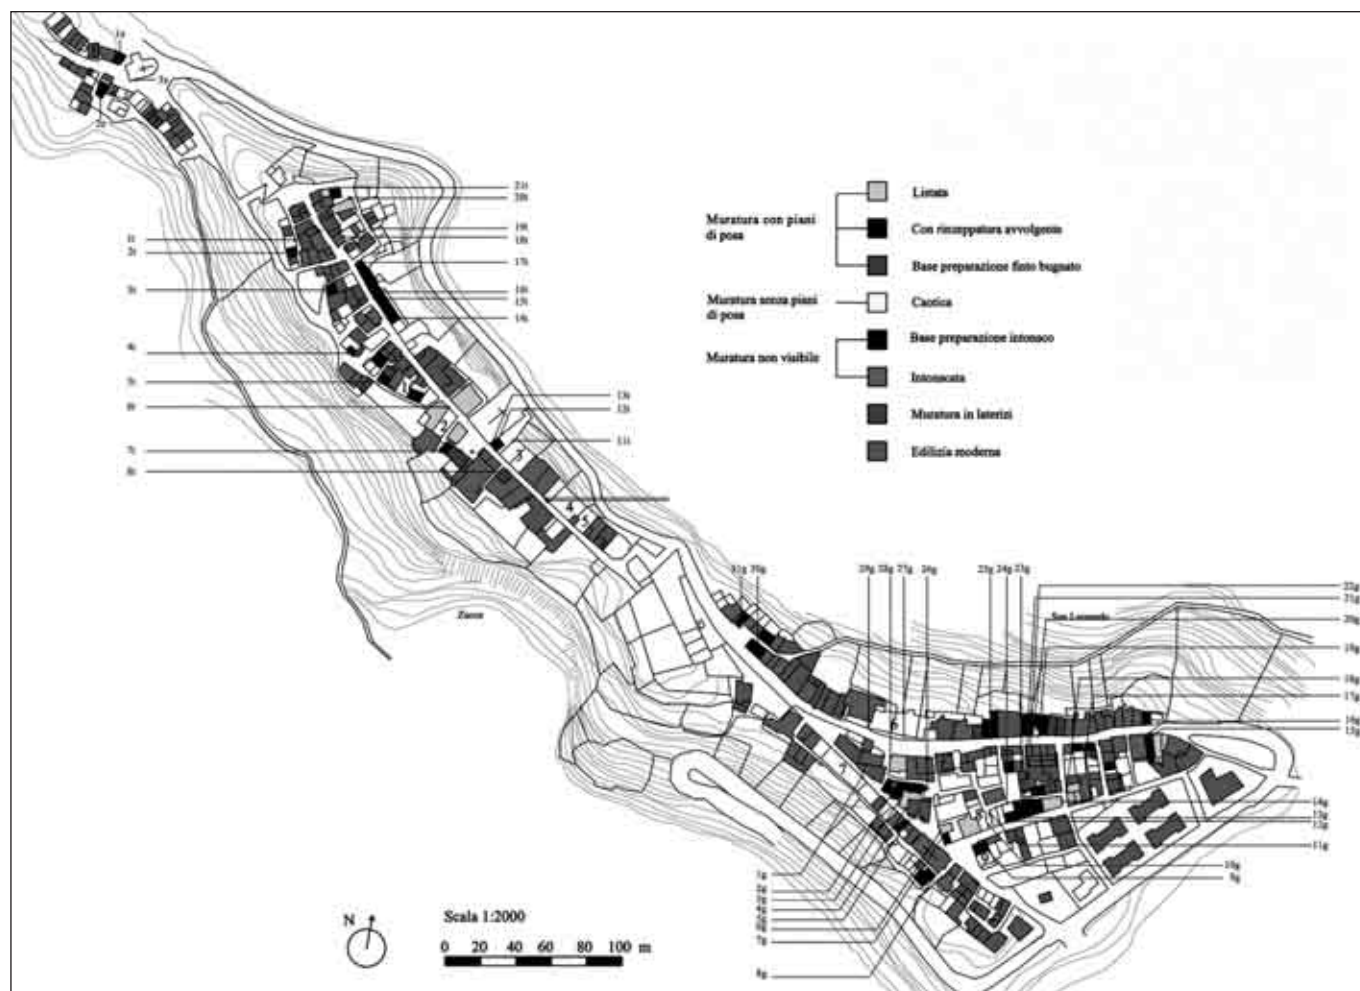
Bovalino. Planimetria del centro con individuazione delle unità murarie esaminate.
